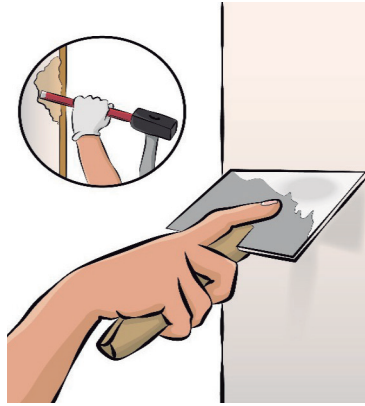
Corrección de fisuras en paredes de bahareque
